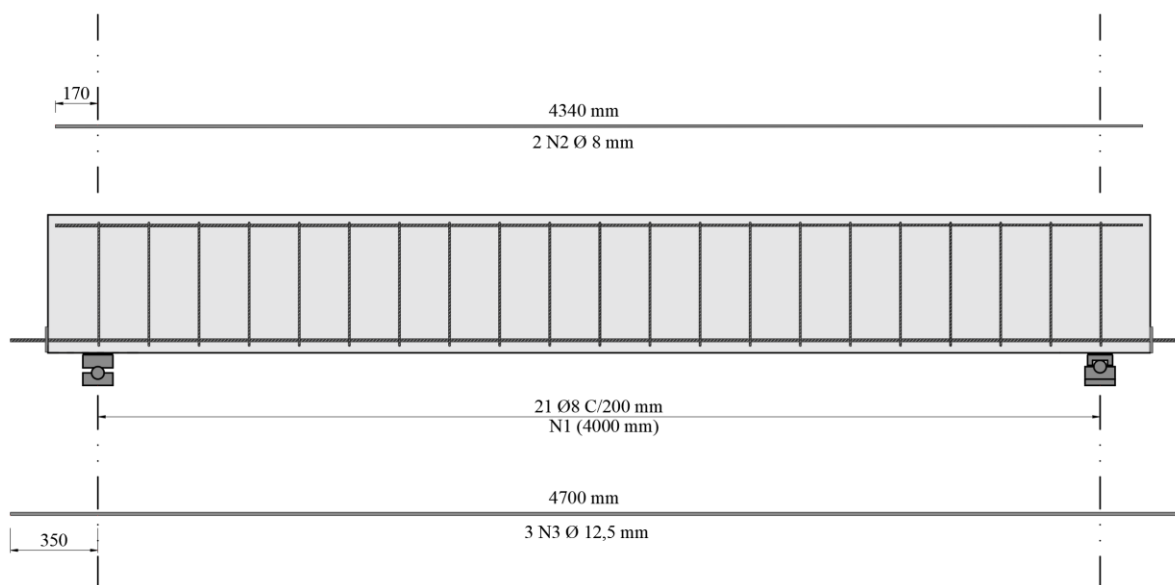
Detalhamento longitudinal das armaduras das vigas ensaiadas.
